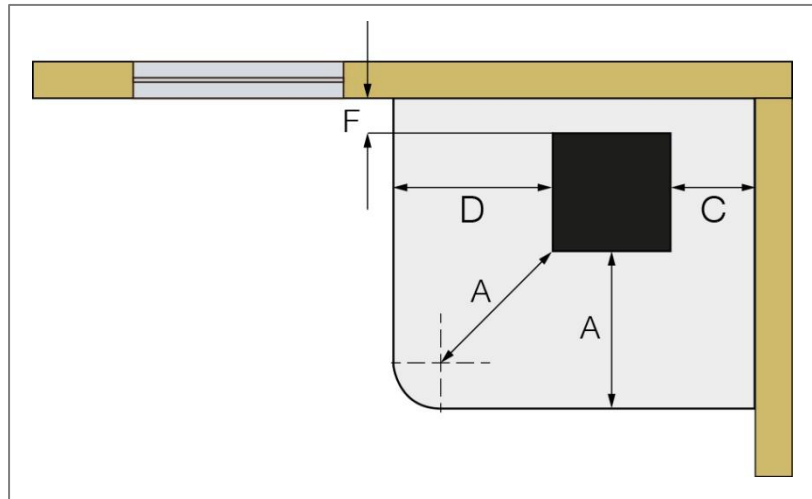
Aufstellung an einer Gebäudeecke, auch spiegelverkehrt gültig mit Gebäudeecke links.
